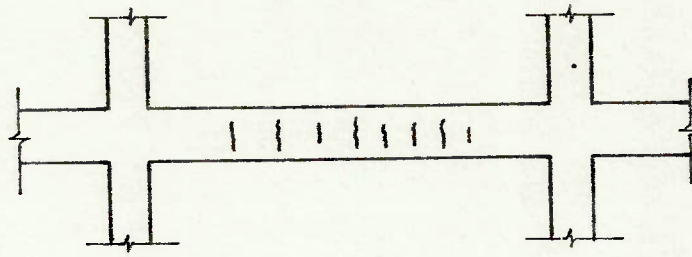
Fissuras de retração numa viga de concreto armado
